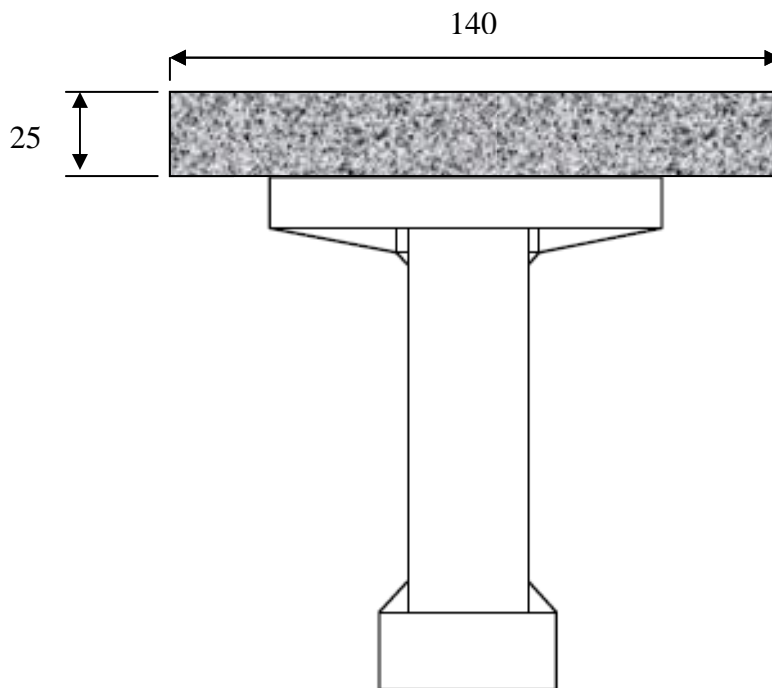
La section d'about de la poutre en BA plus l'hourdis général.
